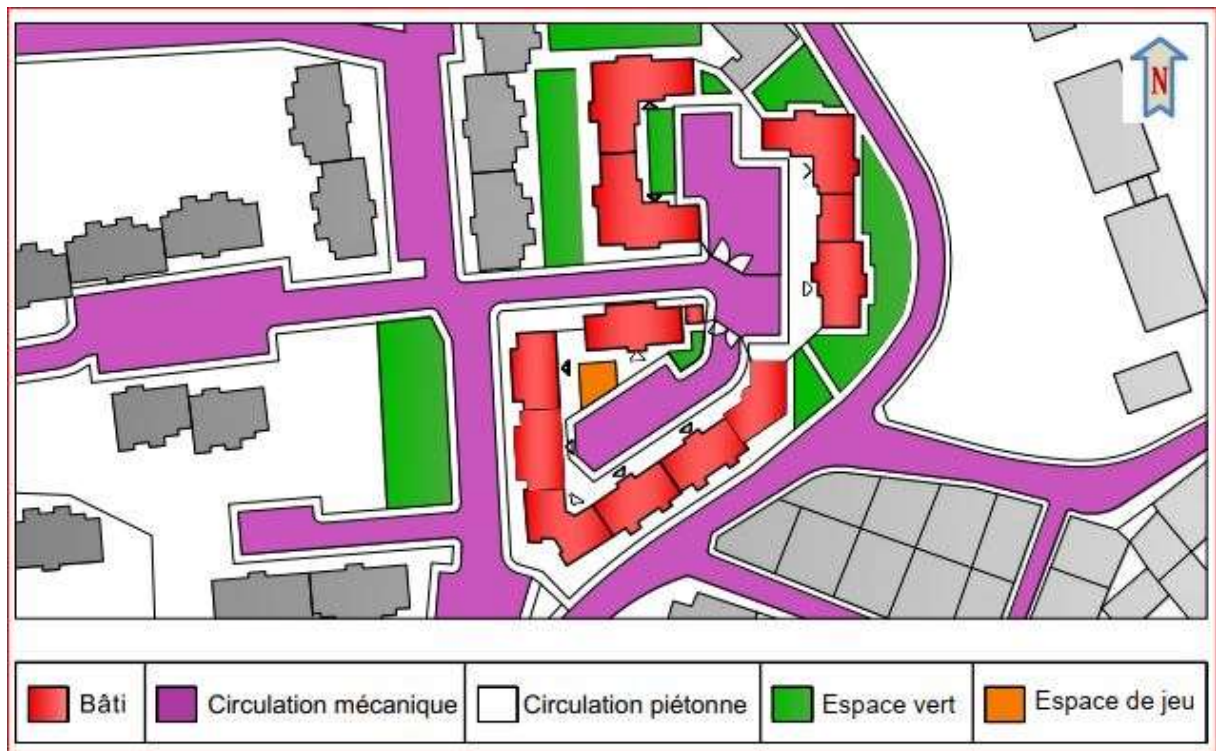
Aménagement du plan de masse. : (Source : adapté par l'auteur à partir du PDAU 2019)
